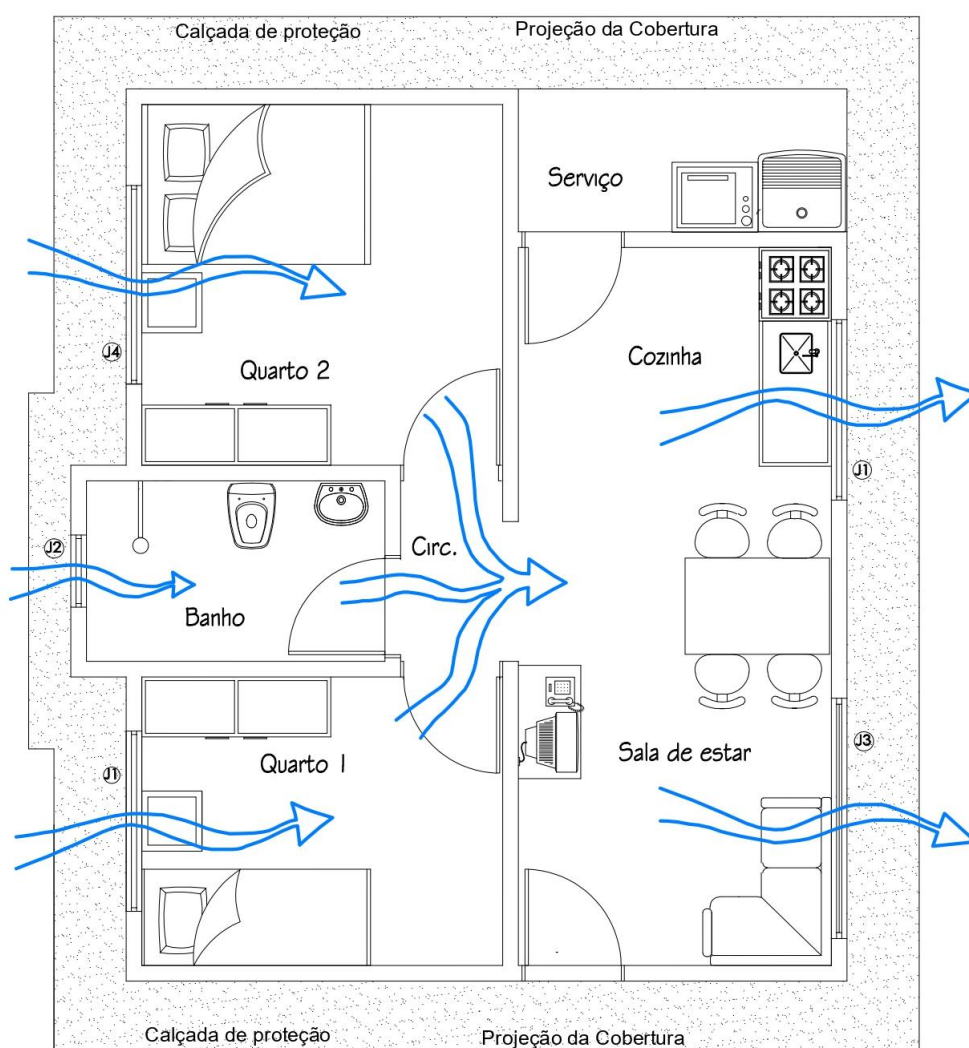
Planta baixa da Casa 1 com alterações nas janelas
